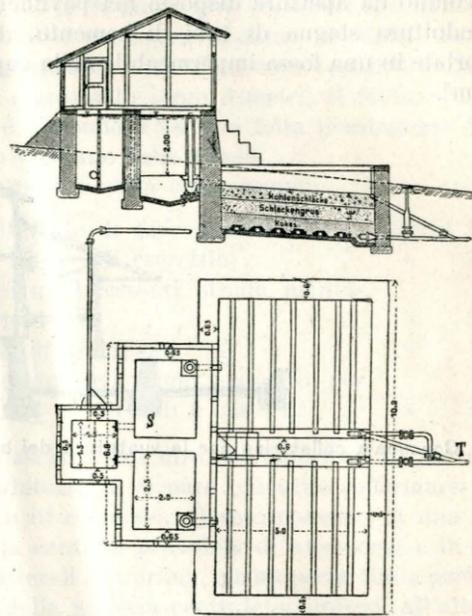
Sezione e pianta dello stabilimento di depurazione biologica a Bertvich.
